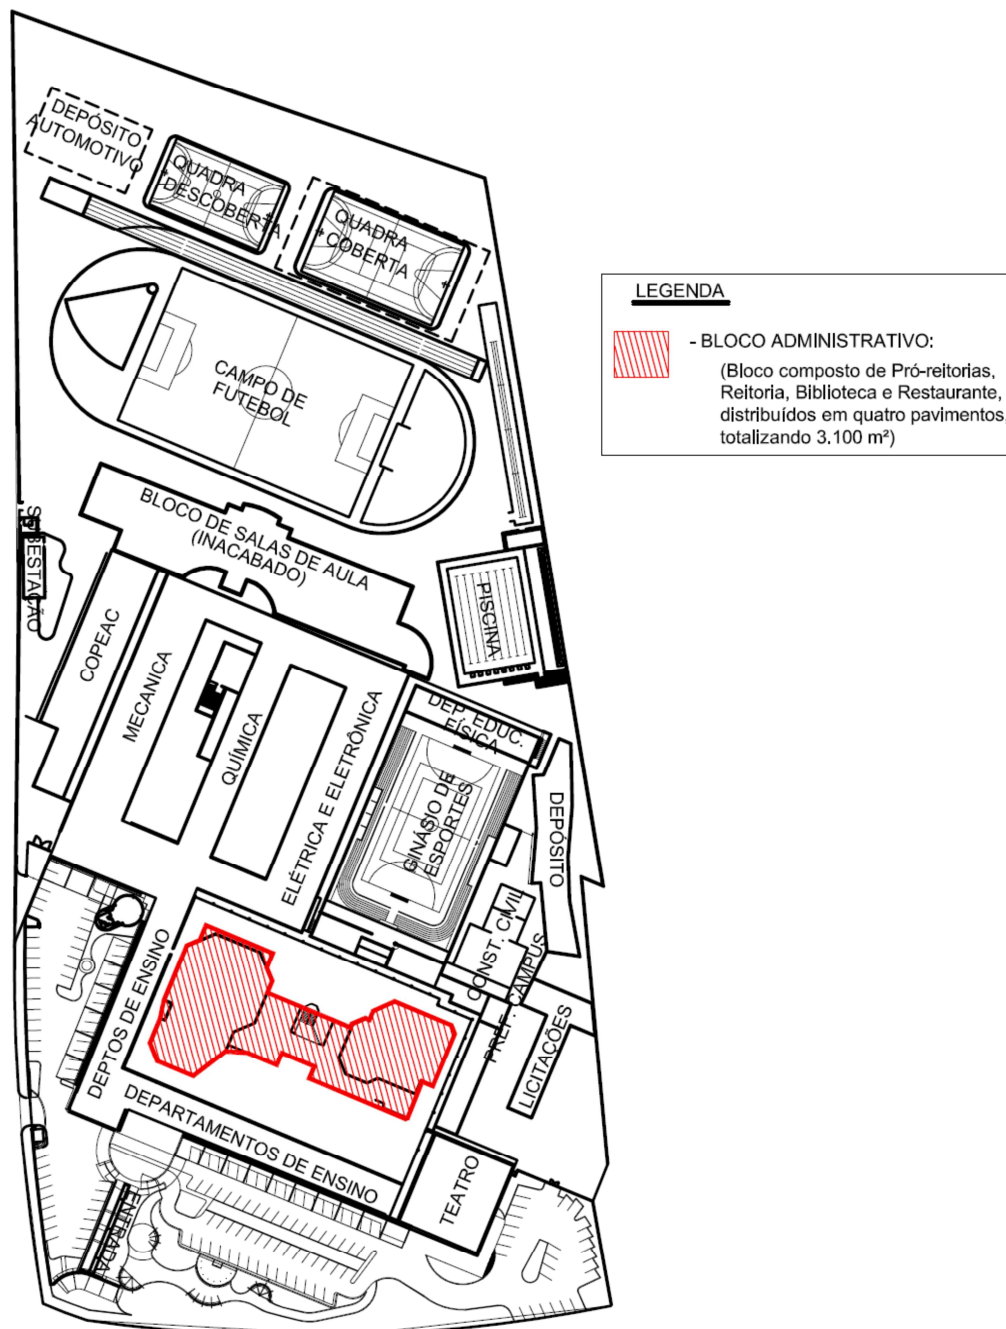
Planta baixa do complexo IFMA - Campus São Luís/Monte Castelo
